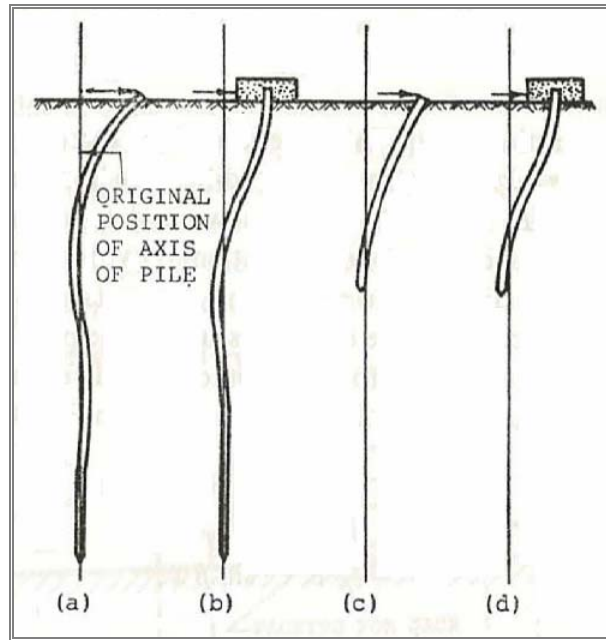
Variación de la deformada en pilotes bajo la acción de cargas horizontales: (a) pilote largo sin restricción en cabeza; (b) pilote largo con giro en cabeza impedido, (c) pilote rígido sin restricción en cabeza; (d) pilote rígido con giro en cabeza impedido (Mohan, 1988)
